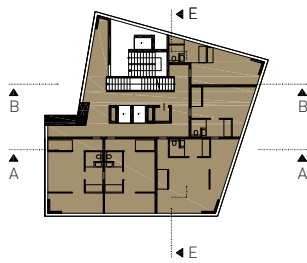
Grundriss Funktionen 6.0G +26,98m
